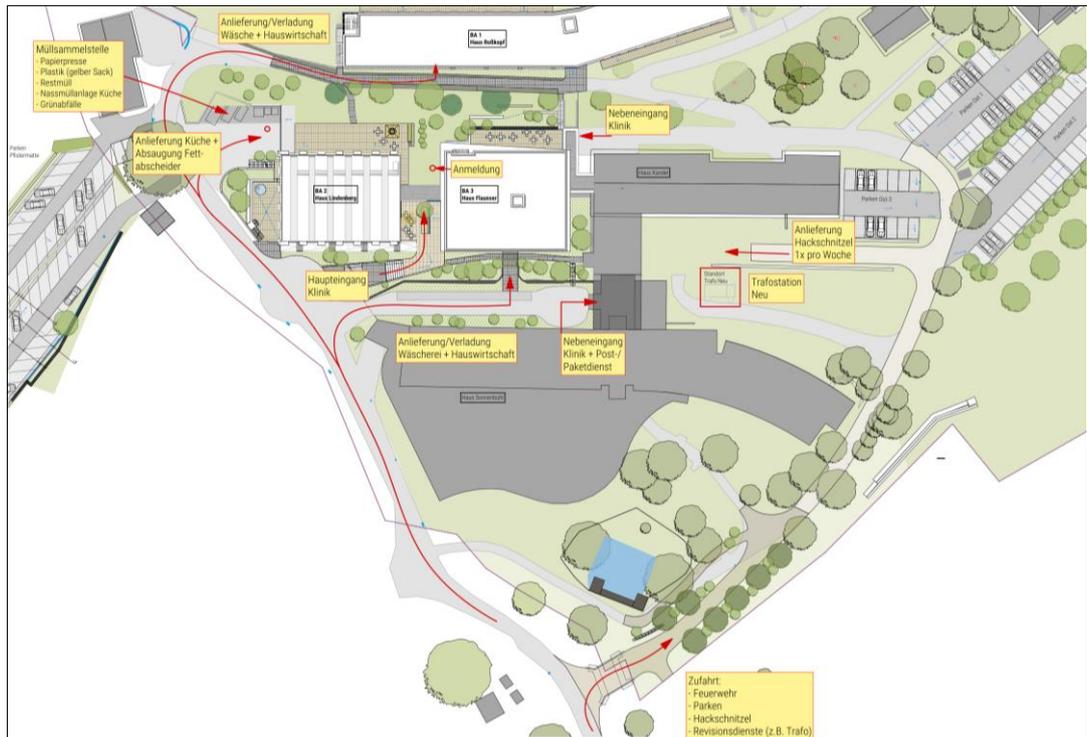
Ausschnitt aus dem Lageplan mit Anlieferverkehr [2]
